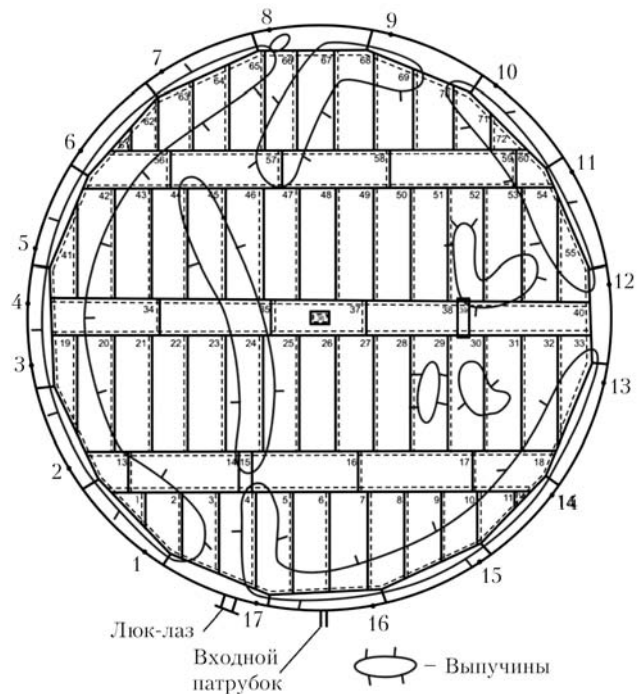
Схема дна внутреннего резервуара: 1-17 — вертикальные сварные соединения 1-го пояса стенки
